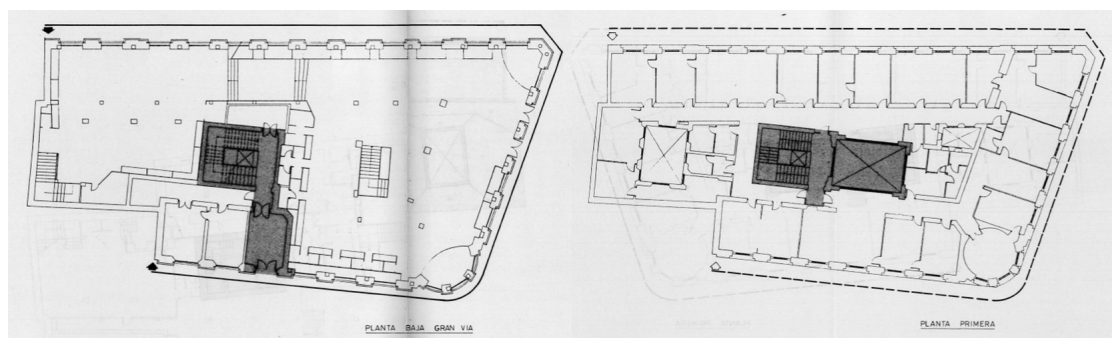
Planimetría presentada por Pedro Salmerón en el proyecto de rehabilitación de 1991
